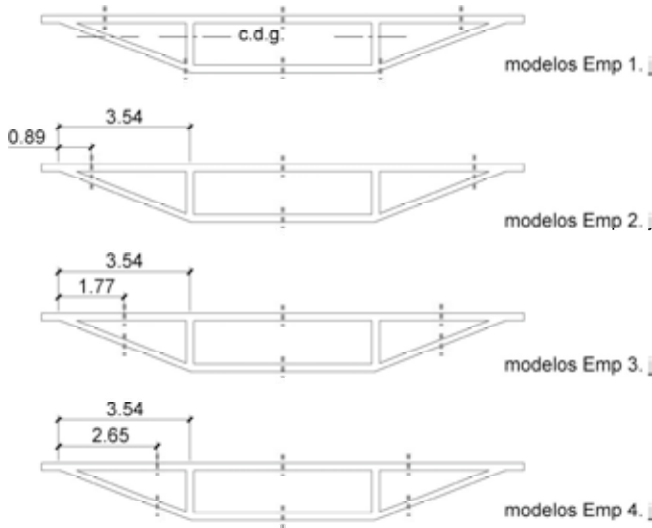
Modelos de Emparrillado Plano. Disposición de Cortes Longitudinales.
